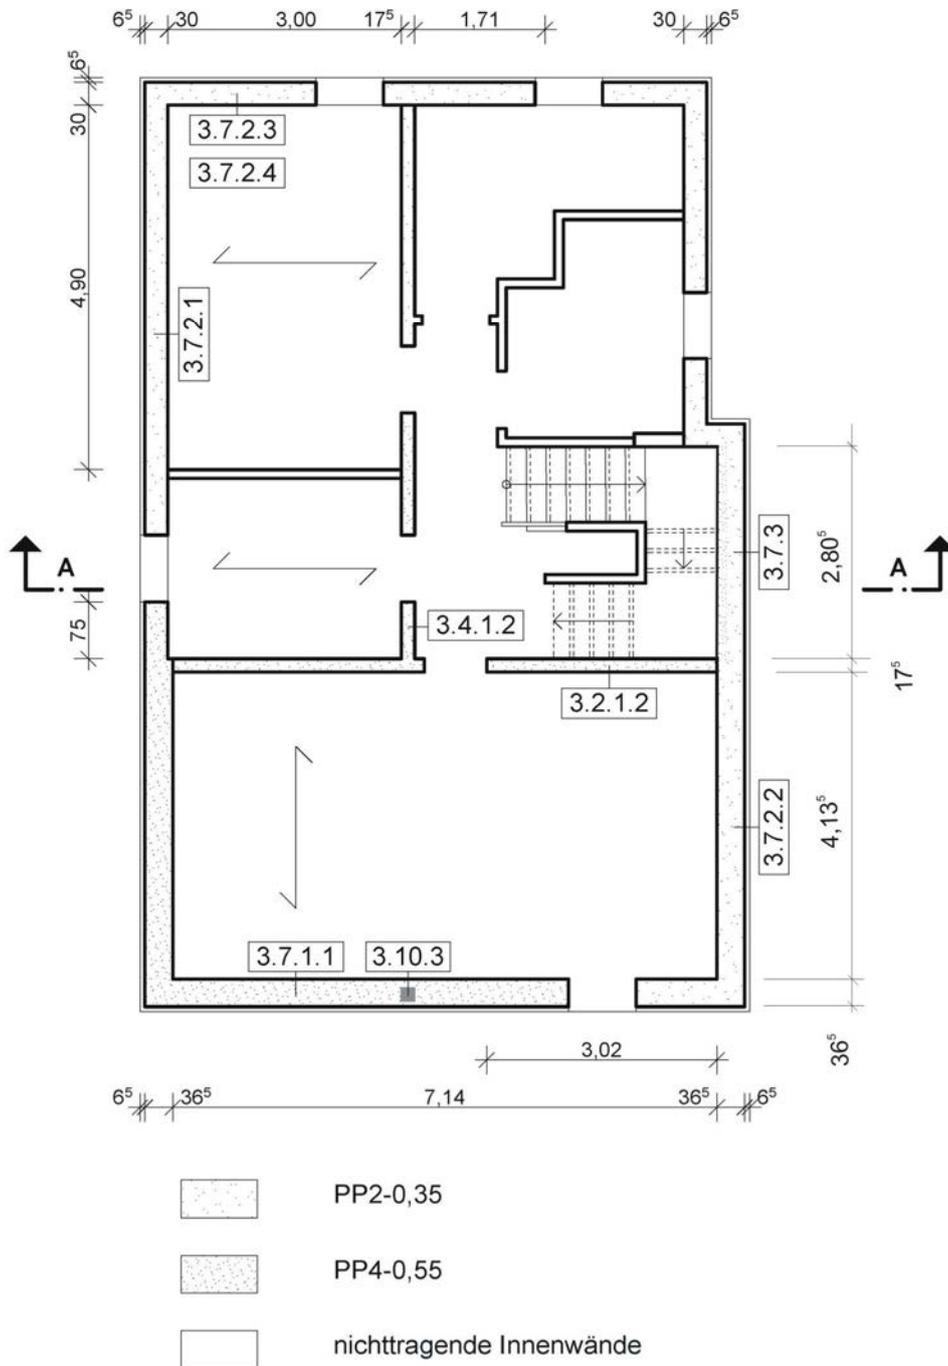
Einfamilienhaus in Berlin, Grundriss Kellergeschoss
